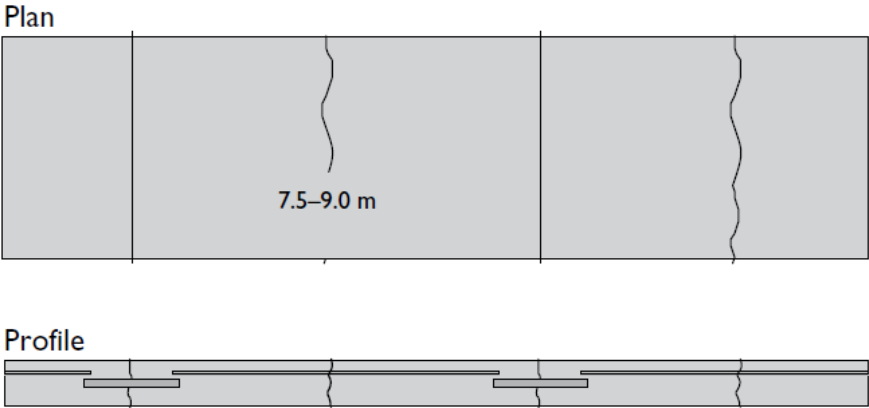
Esquema del pavimento de concreto reforzado (Jointed reinforced concrete pavement (JRCP)). (Fuente: ACPA)
